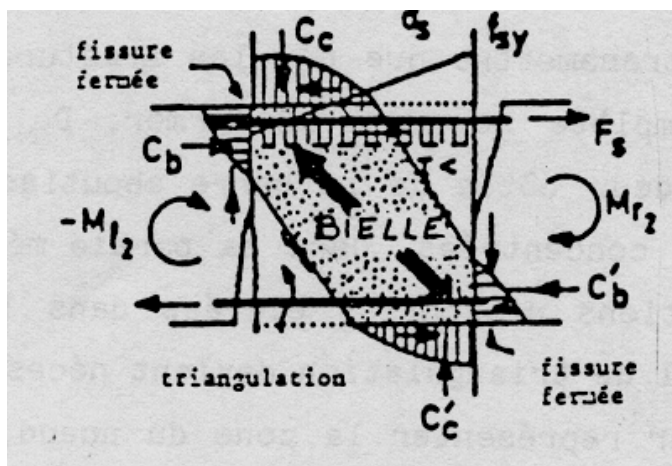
Bielle de compression développée au nœud poutre poteau.
